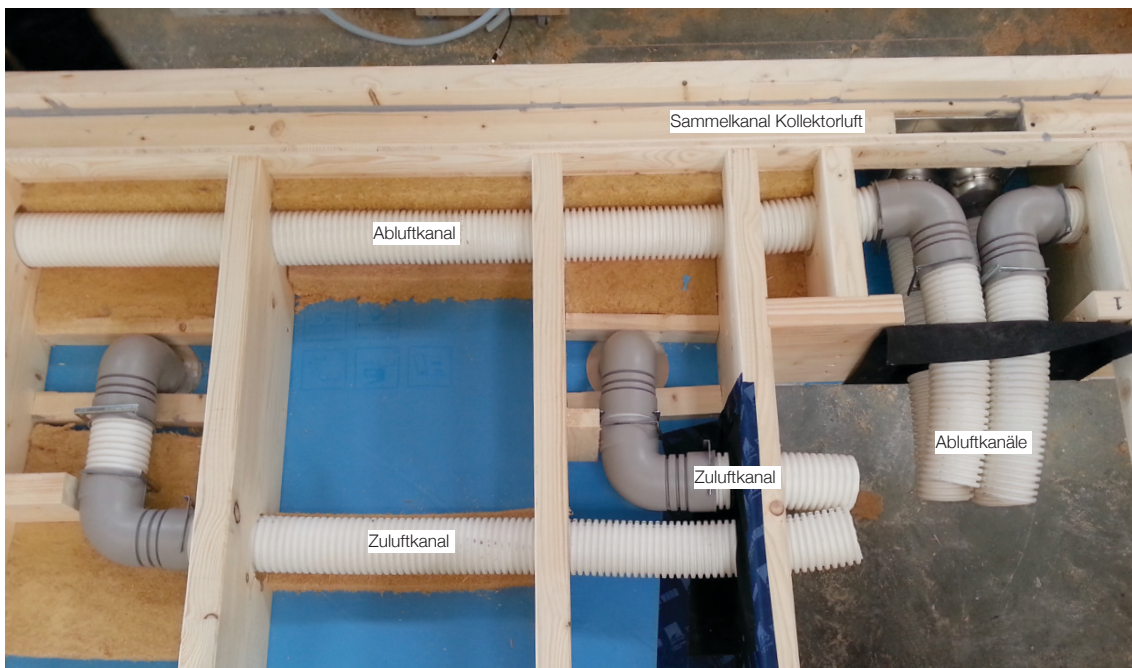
Holzrahmenelement mit Lüftungsleitungen (Foto: BAUFRITZ)
